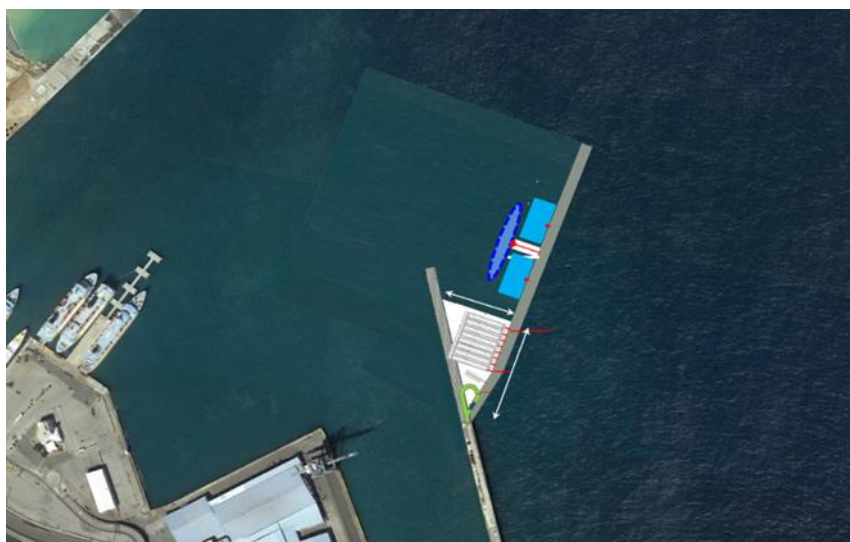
Layout ipotesi progettuale 2<sup>29</sup>.
